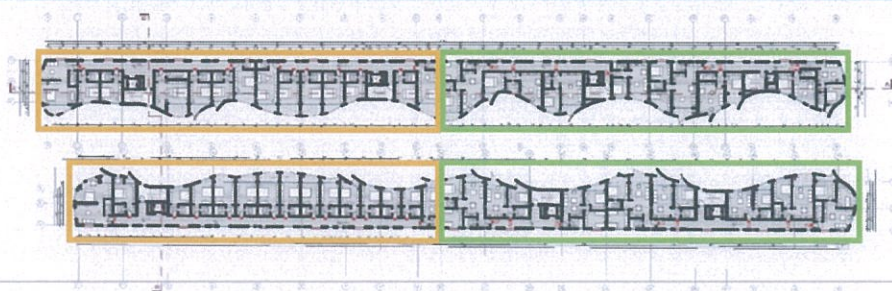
Planimetria e Katit të Parë _ HOTEL DHE APART - HOTEL
